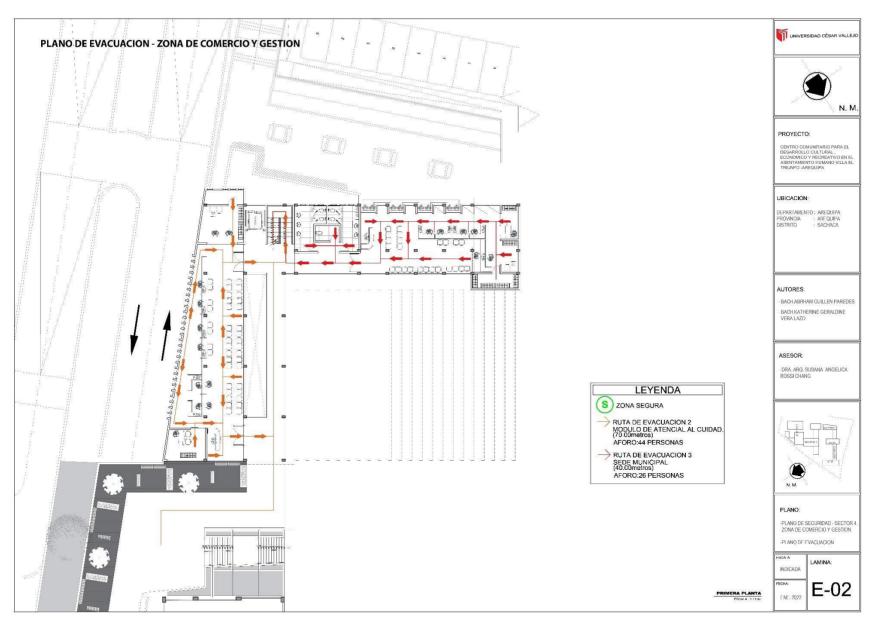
Plano de Evacuación Primera Planta (Sector 4 - Zona de Comercio y Gestión) - Elaboración propia.
